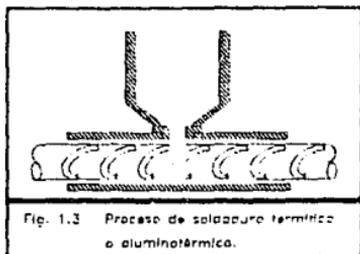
Proceso de soldadura termítico o aluminotérmico.
